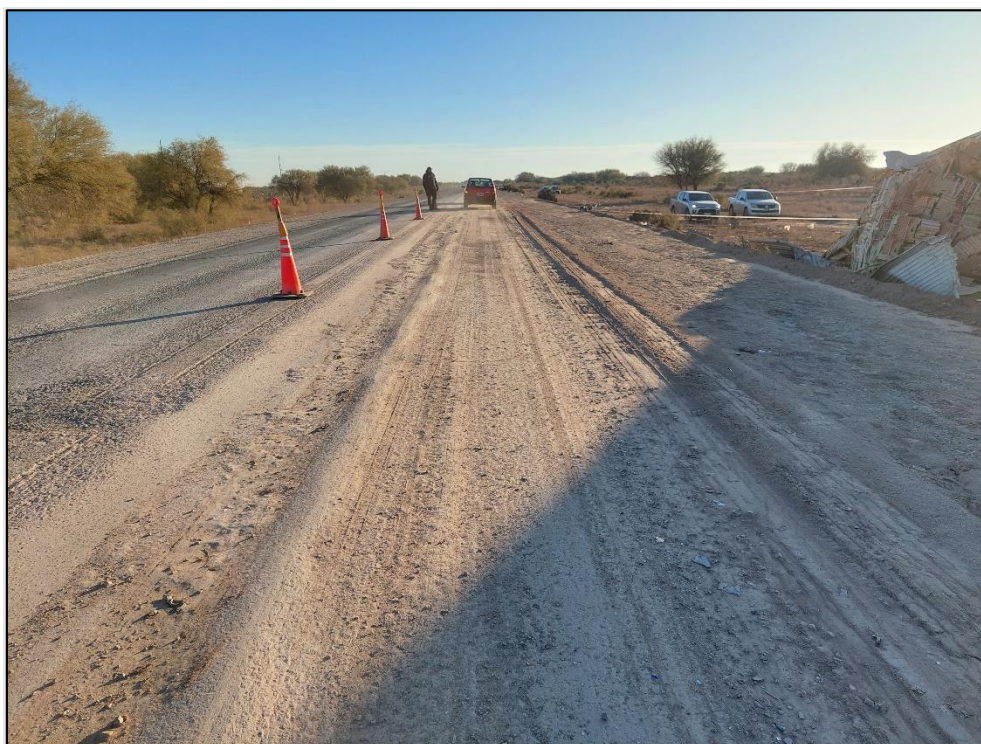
Carril cardinal este (mano hacia San Juan). Se observan fallas sobre el pavimento y tierra sobre la calzada. Fuente: JST, 2022
